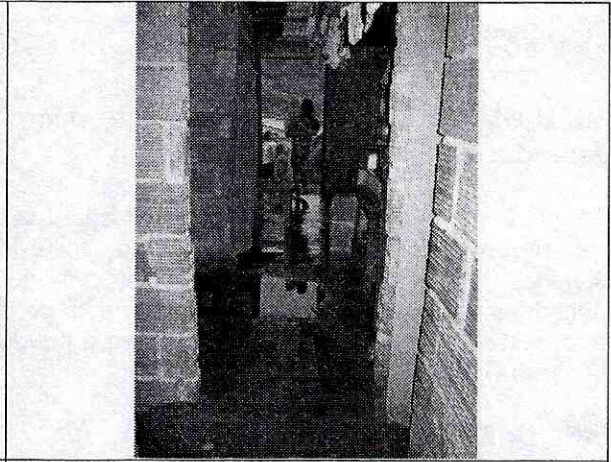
Vista al interior de la vivienda, se presenta anegación con una altura aproximada de 5cm de lamina de agua en distintos sectores del predio
